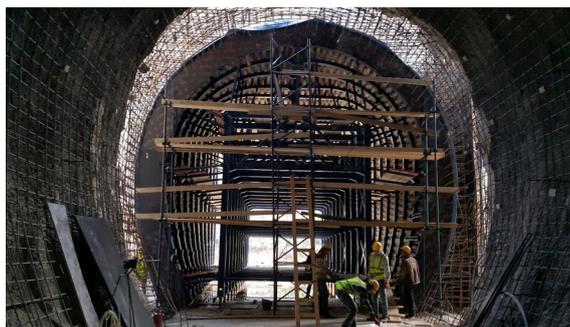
Construção da estrutura de entrada e saída do túnel de desvio de um rio
